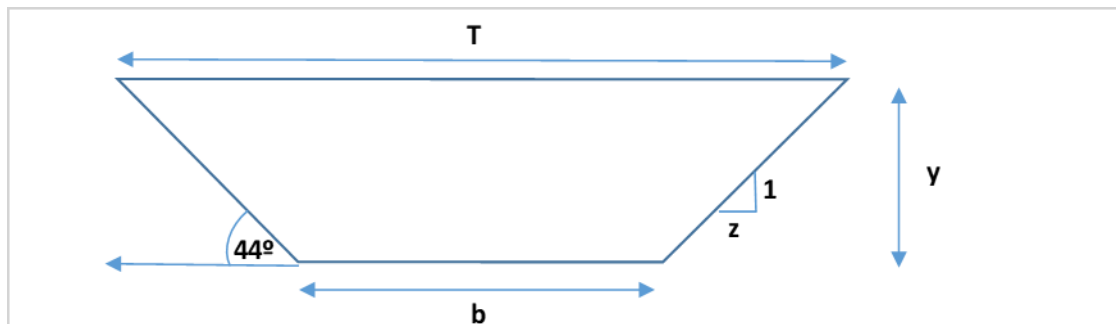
Sección transversal del canal de estudio. Fuente propia del autor
